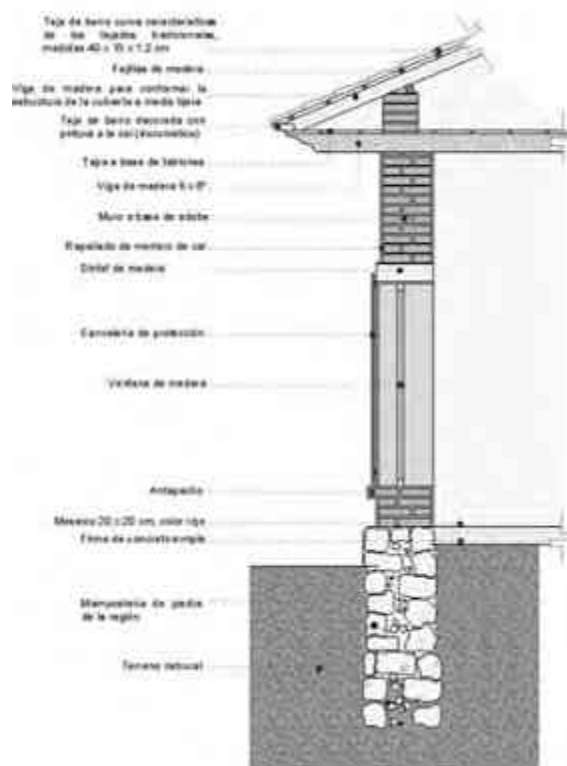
Corte por fachada de la vivienda Sánchez. Fuente: J. J. Segura Granados.
